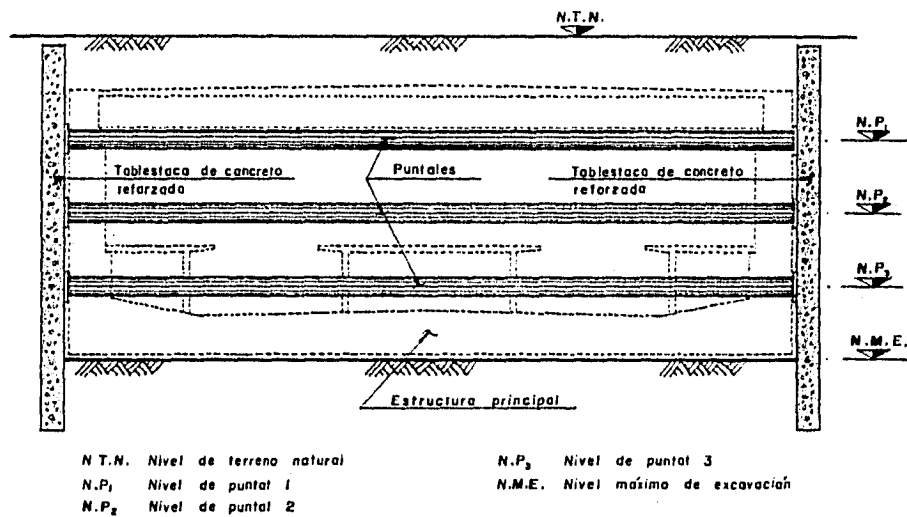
SECCION TRANSVERSAL DE UNA EXCAVACION
